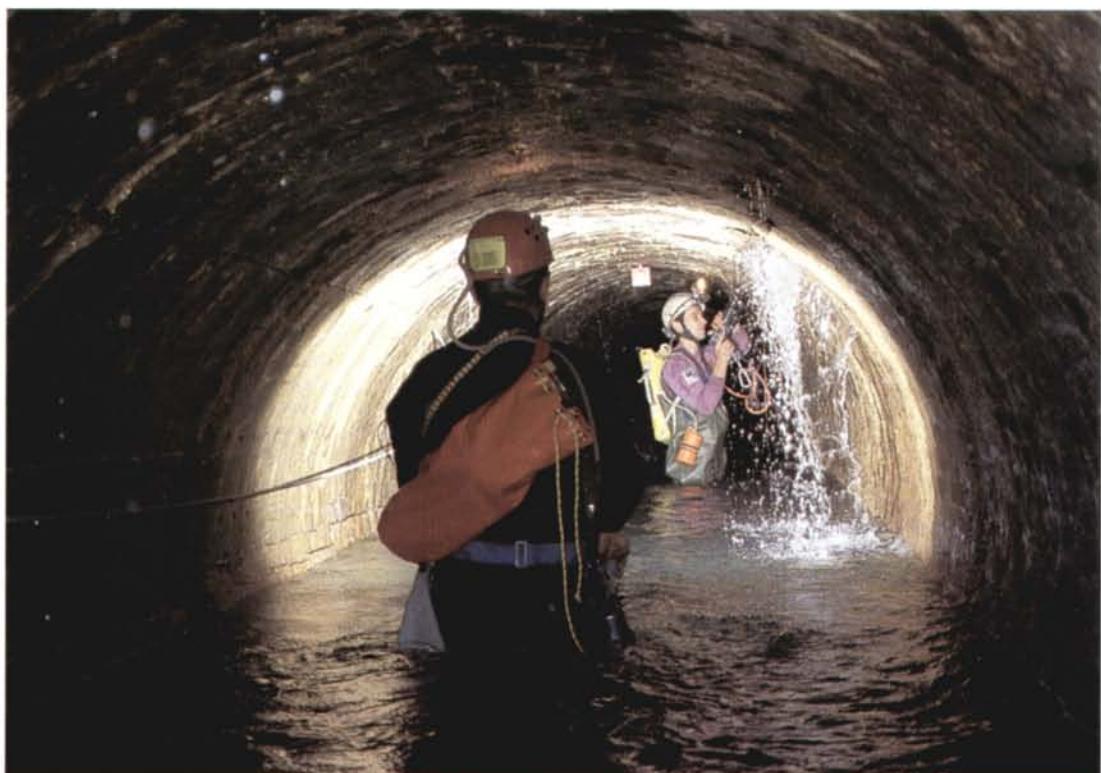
e 12 (pag. a fianco): Abbondanti infiltrazioni d'acqua dalle fessure della galleria (foto G. Badino e M. Chiesi).
